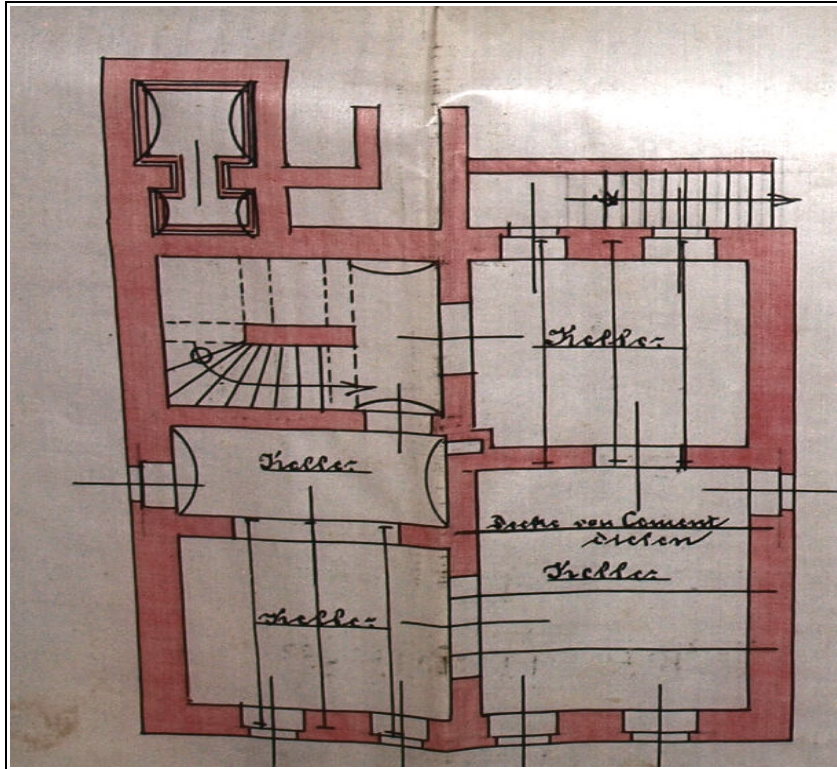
Grundriss Kellergeschoss ZFH
